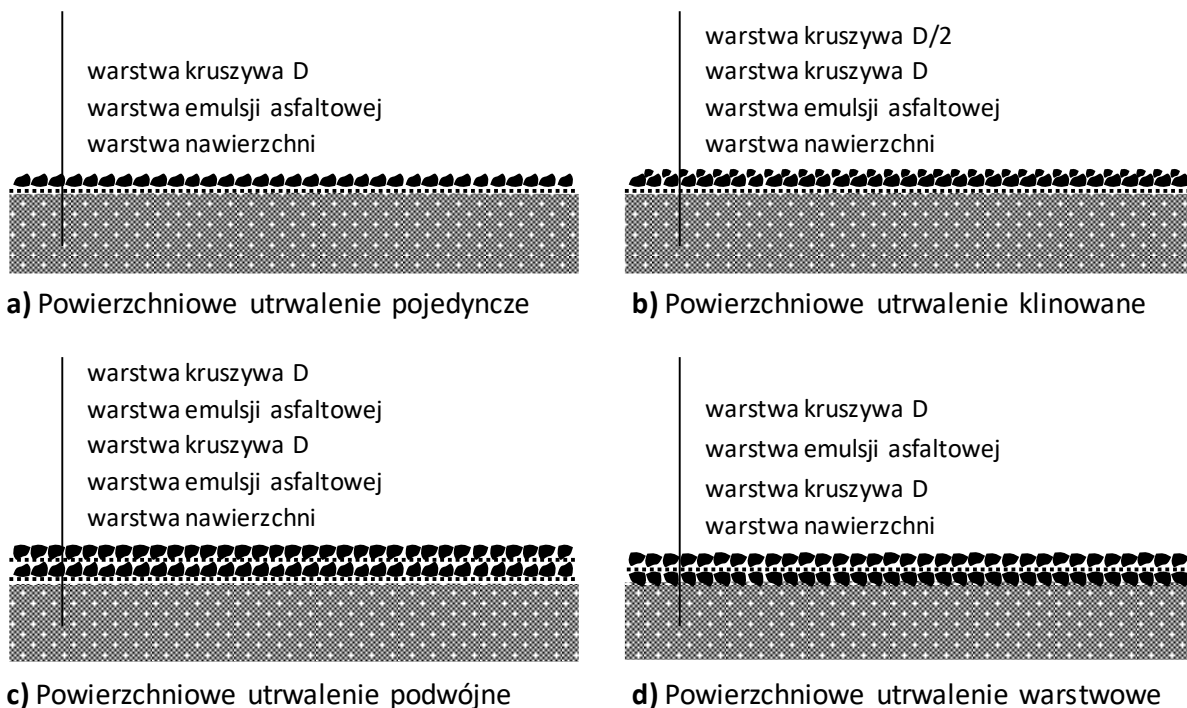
Przykład powierzchniowego utrwalenia
